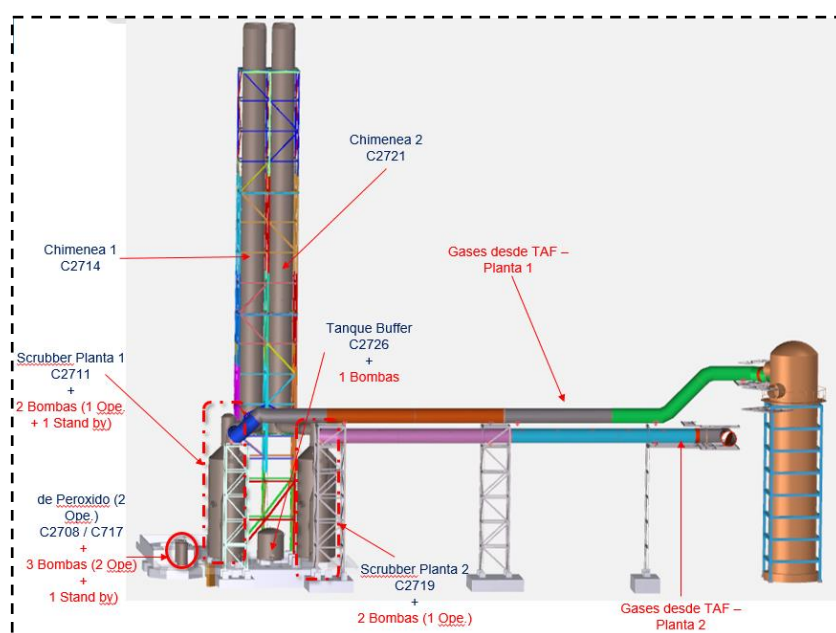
Vista General de Planta Lavador de Gases en la Planta de Ácido (35)
